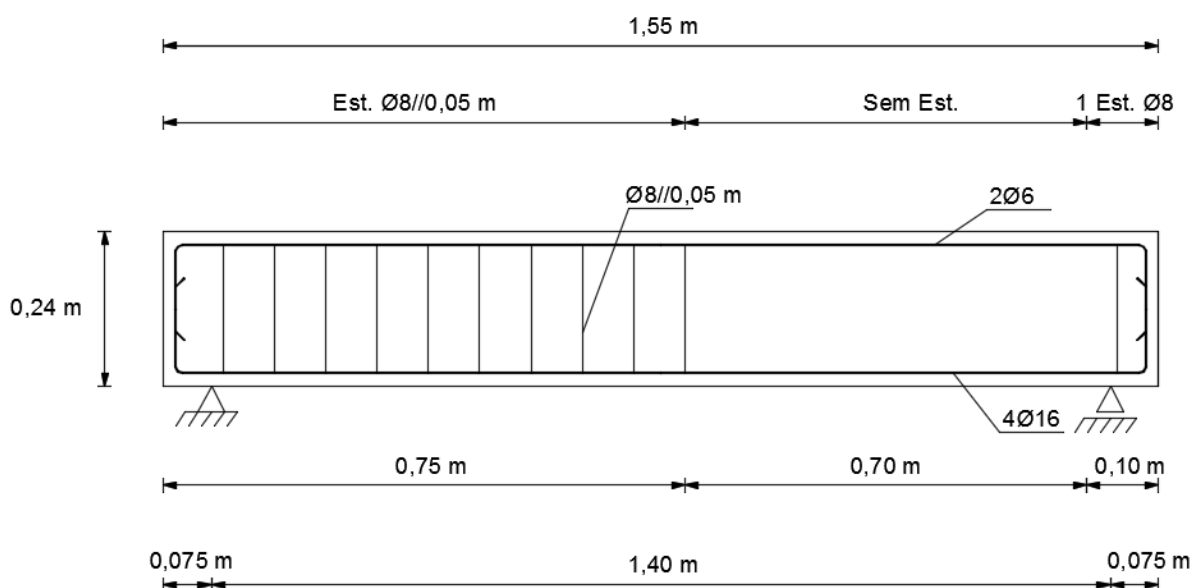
Corte longitudinal de viga-tipo – ensaio ao corte
